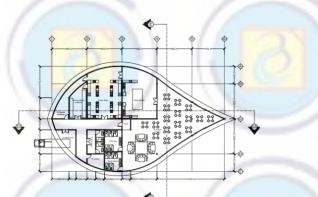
11 Tampak Massa Bangunan Pengelola
